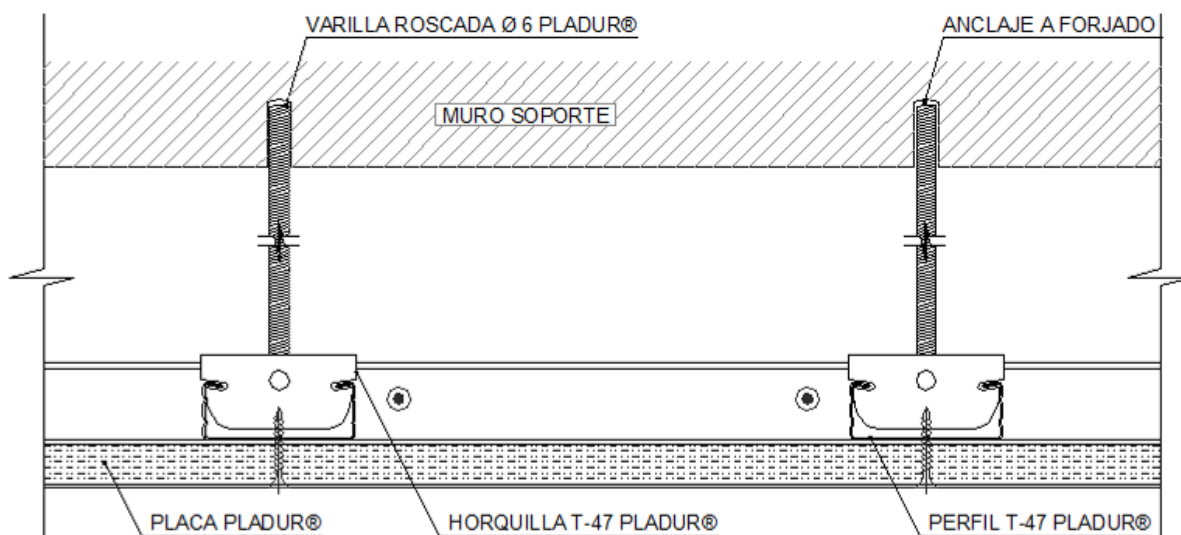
Pormenor tipo tecto falso em gesso cartonado [Pladur®, 2020]
